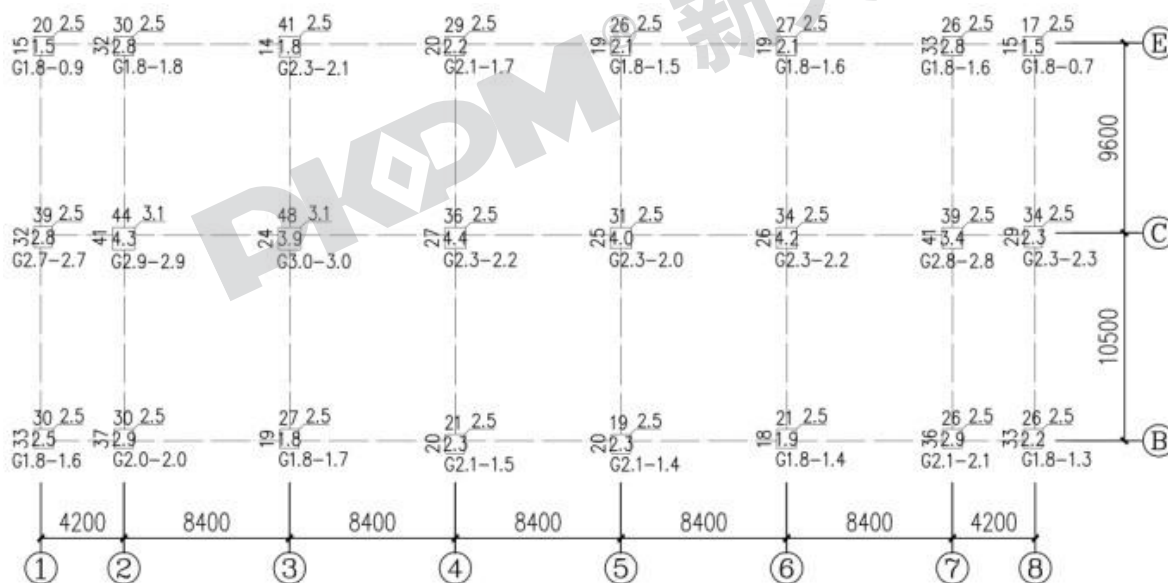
第3层混凝土构件配筋简图(单位:cm*cm)
